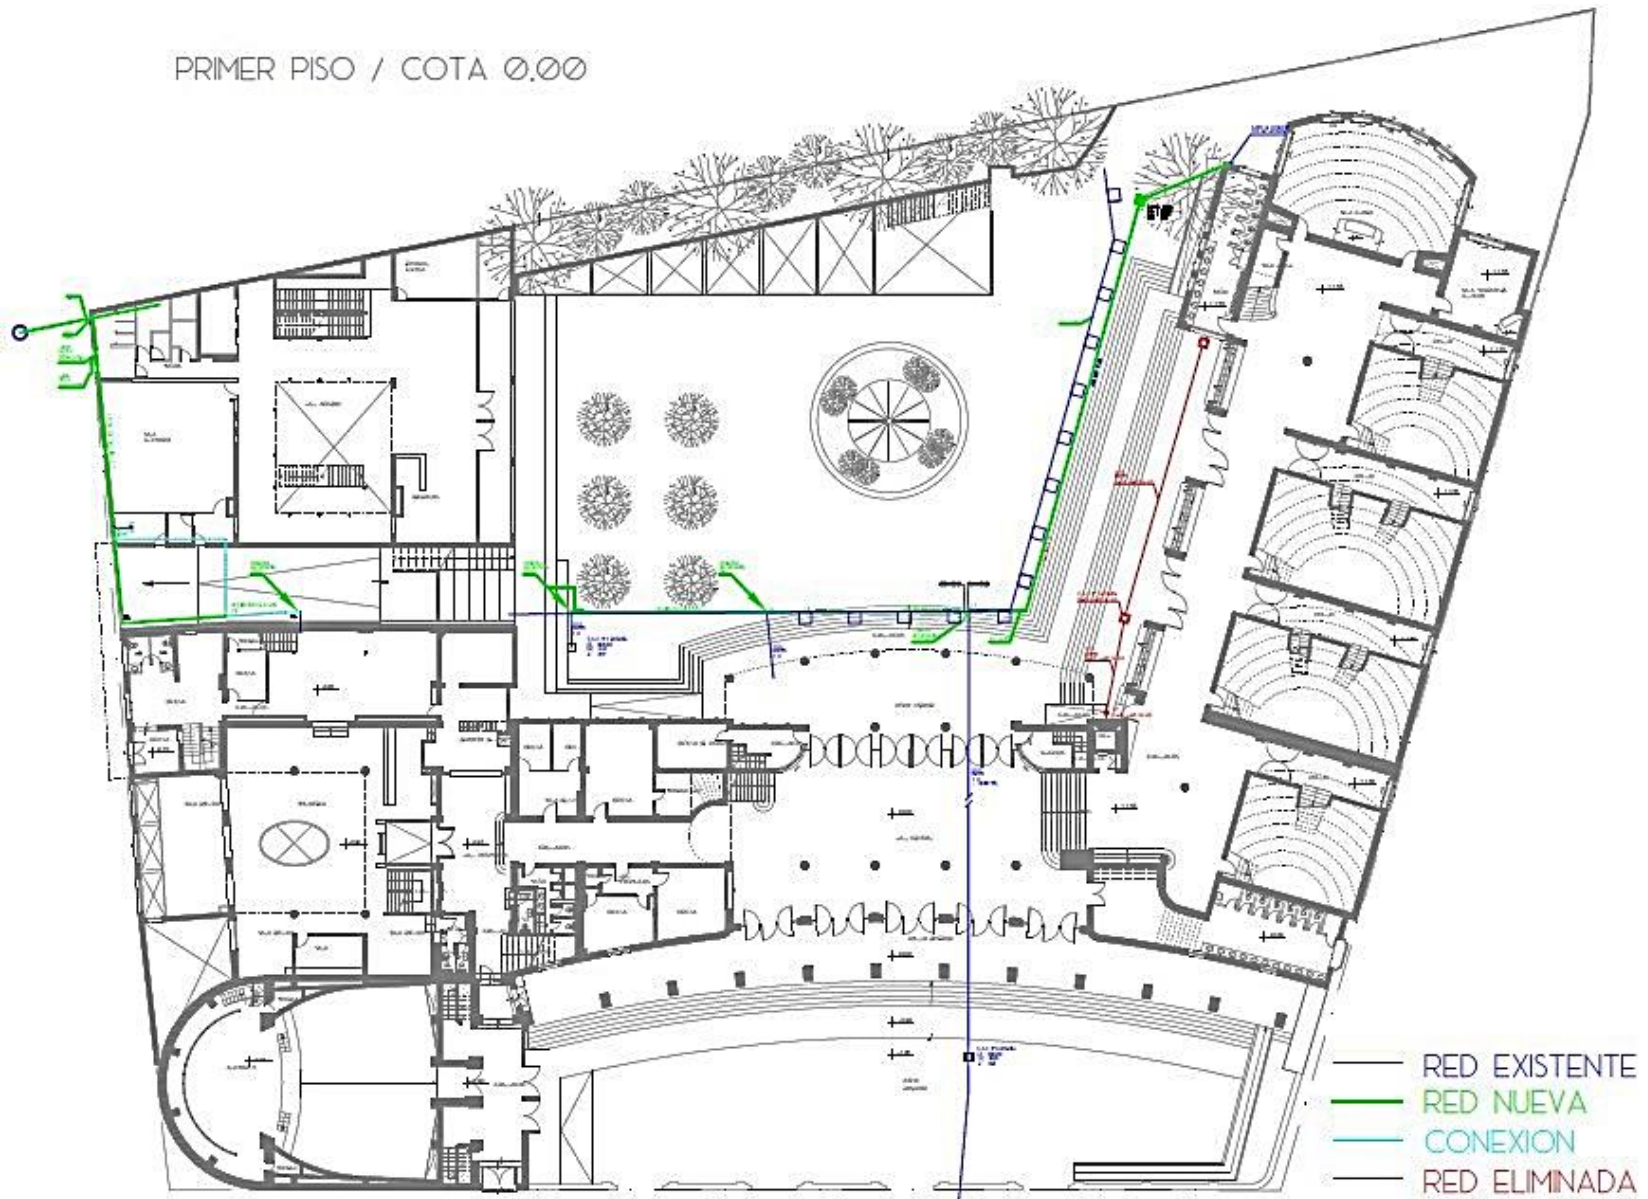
Planta Esquema Alcantarillado, Creación Propia.
